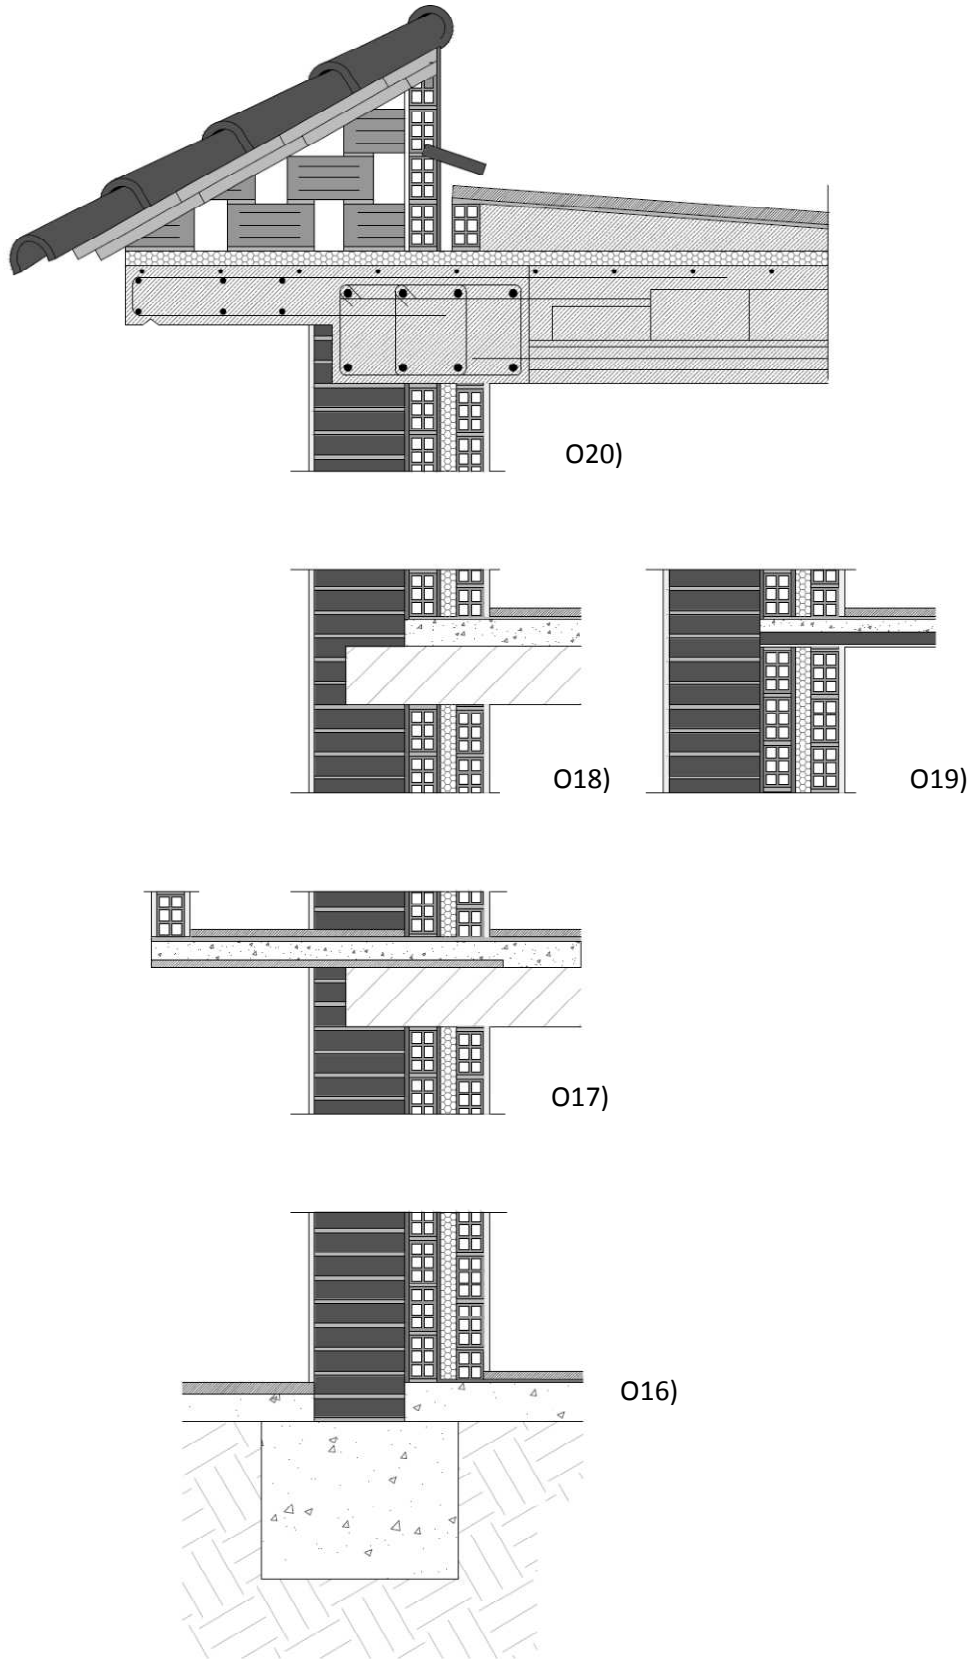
Sección constructiva. Zona oeste. Estado rehabilitado.
